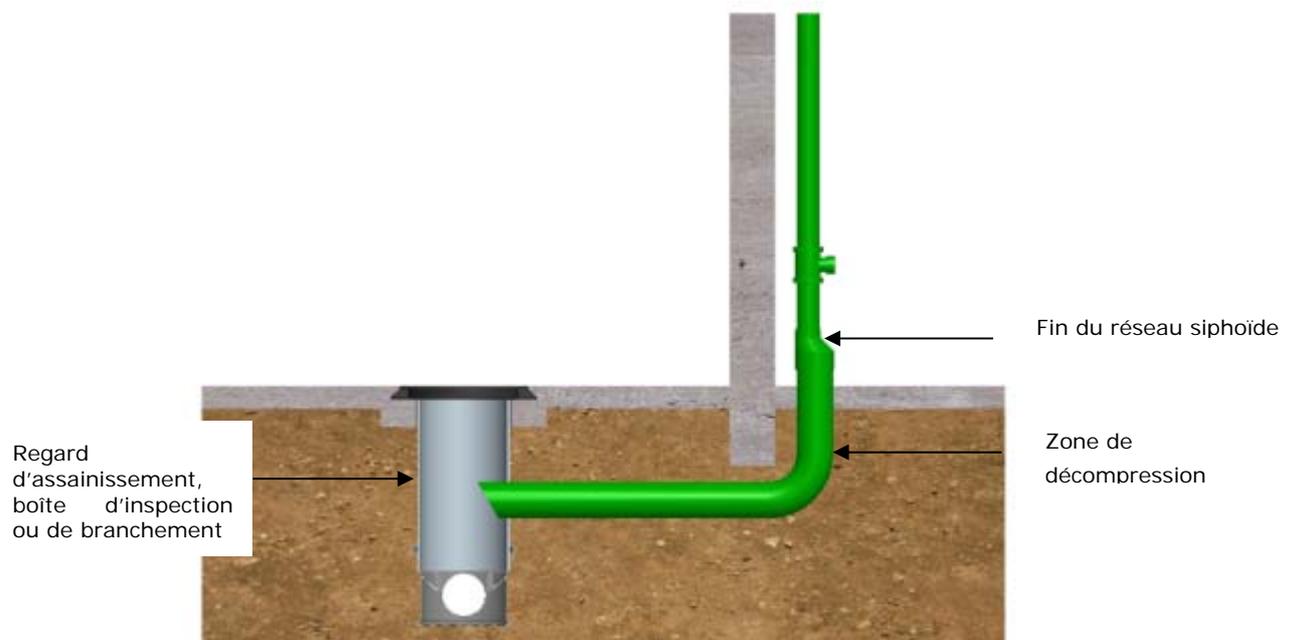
Raccordement au réseau gravitaire par l'intermédiaire d'un dispositif d'accès au réseau d'assainissement
